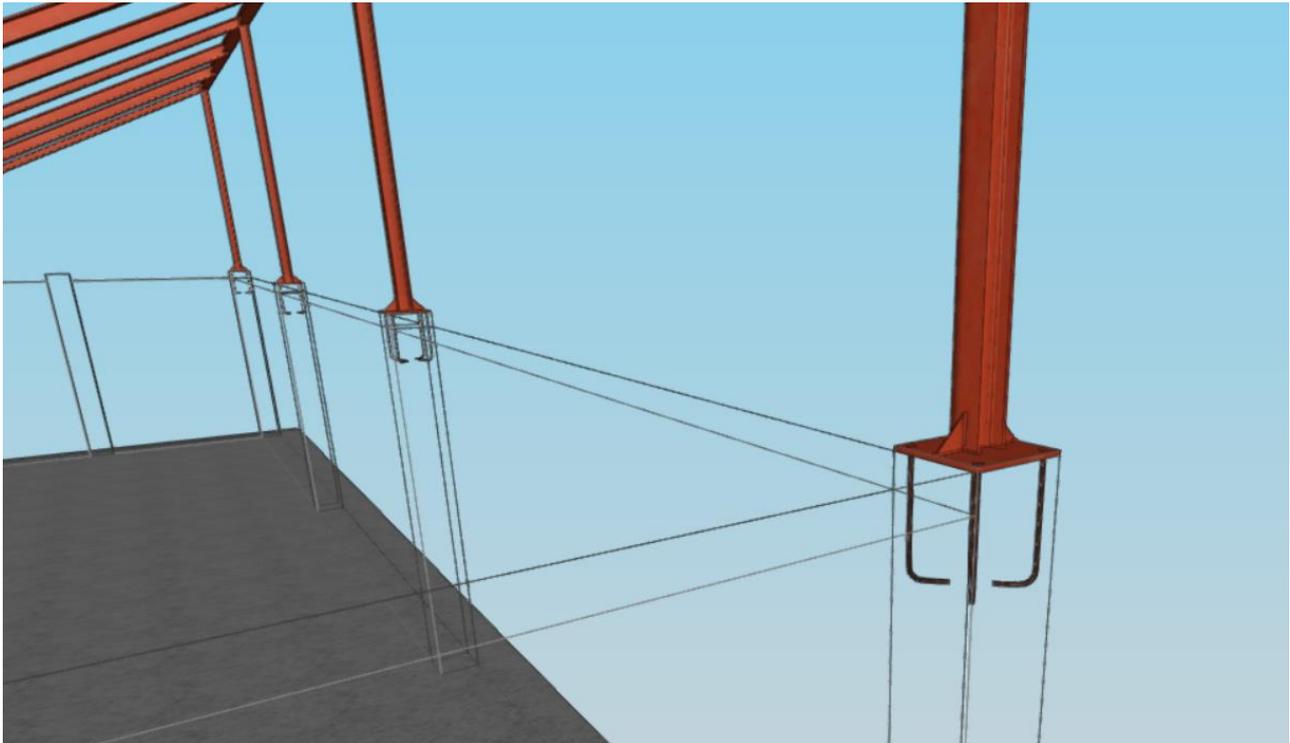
Uniones de los pilares de la estructura metálica con los de hormigón armado.
